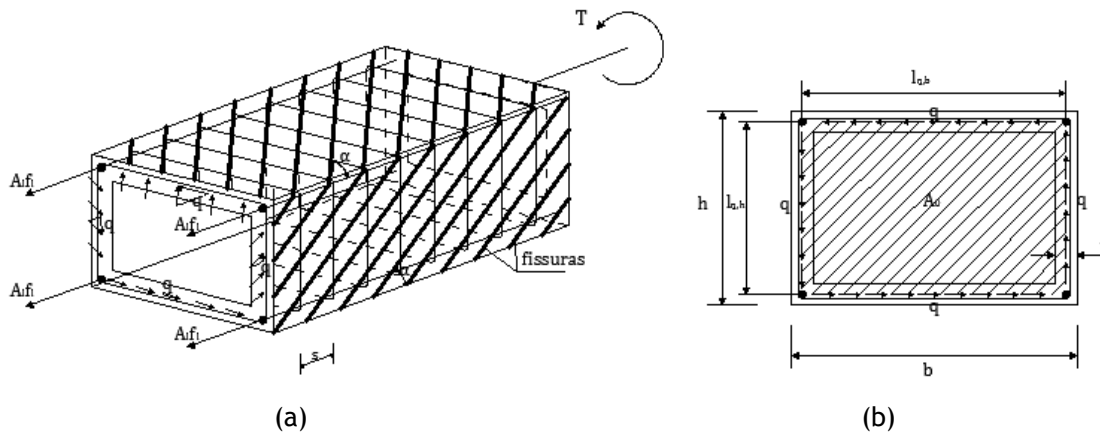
Viga com secção retangular vazada sujeita à torção pura
